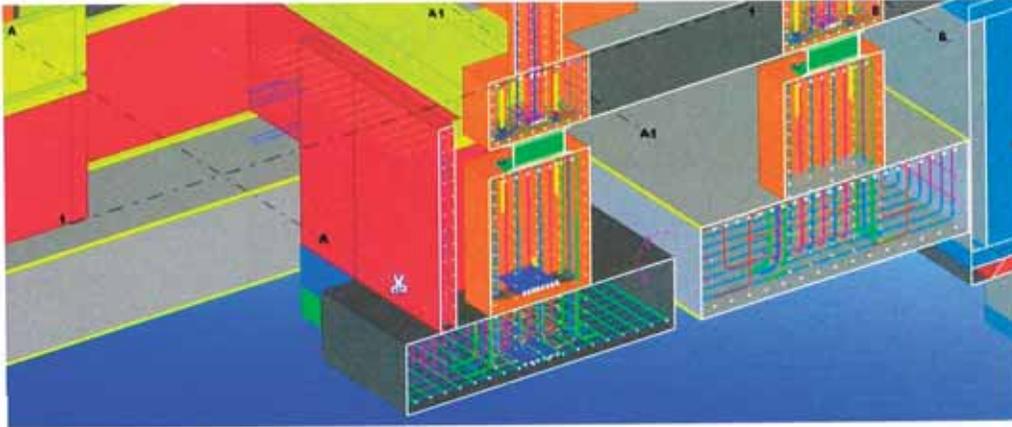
Herramienta Tijera de Tekla Structures
